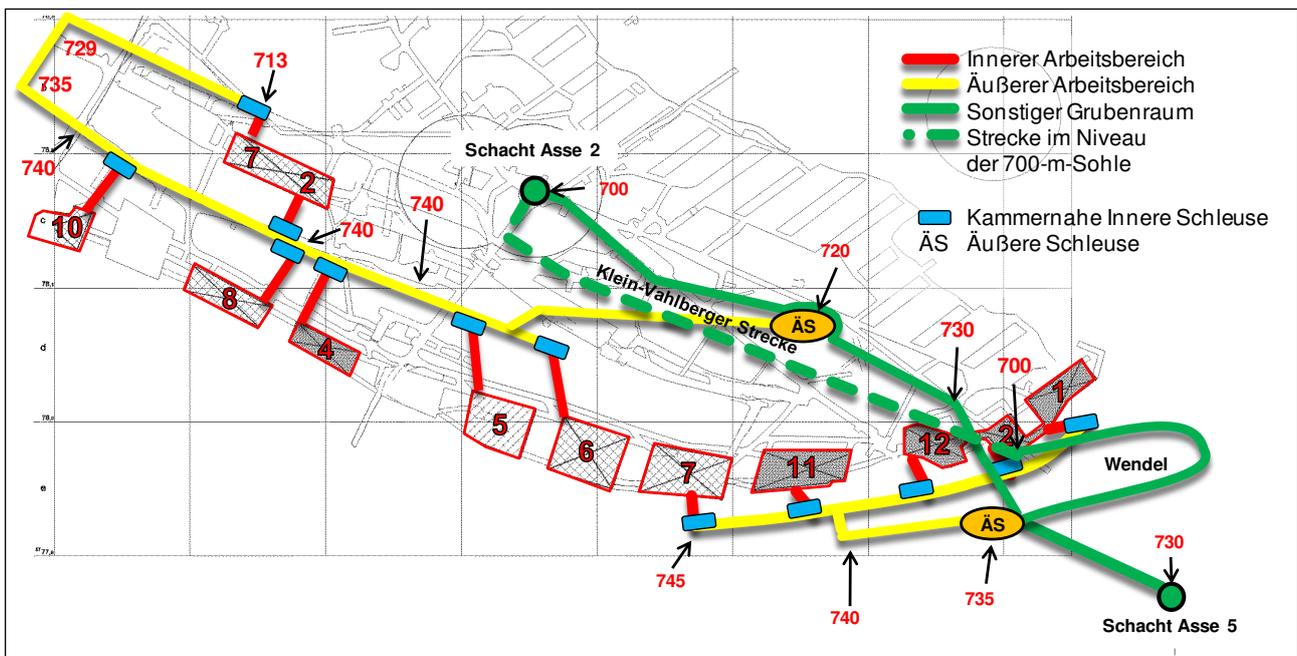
Schematische Darstellung der Mischvariante mit kammernahen Inneren Schleusen an beispielhaften Orten (Hintergrund: Grundriss der 750-m-Sohle)
